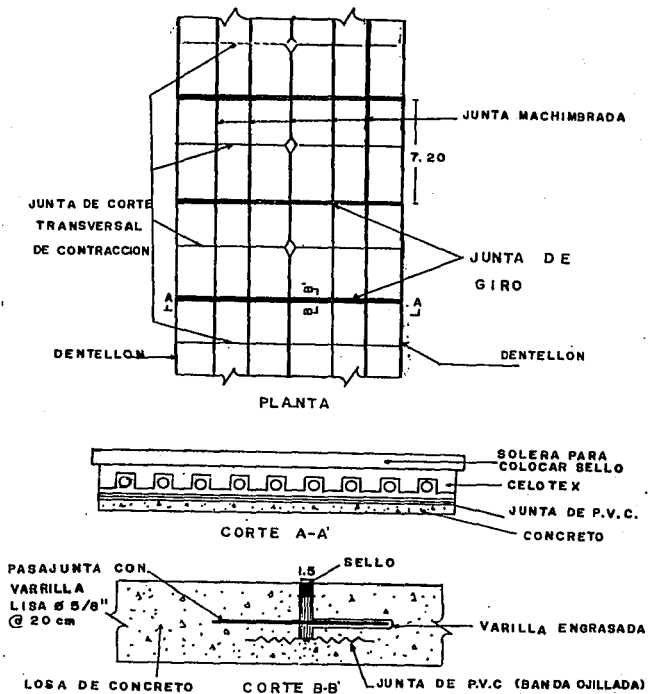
DETALLES Y CORTES DE JUNTA DE GIRO.
